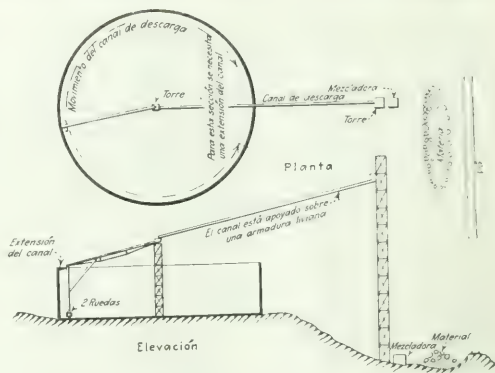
APARATOS PARA EL VACIADO DEL HORMIGÓN
